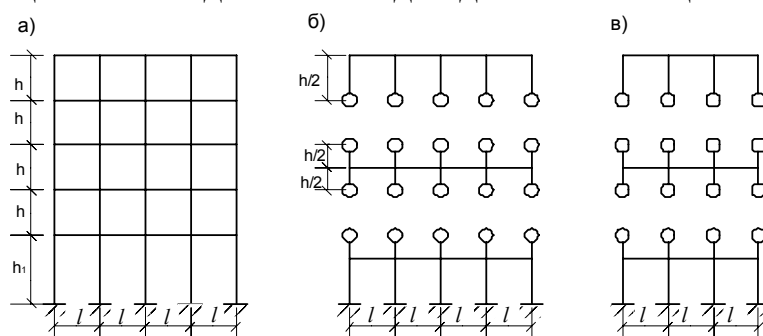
Розрахункова схема каркасної багатоповерхової багатопрольотної будівлі (а). Спрощення цієї схеми для реалізації в табличних розрахунках (б, в)
